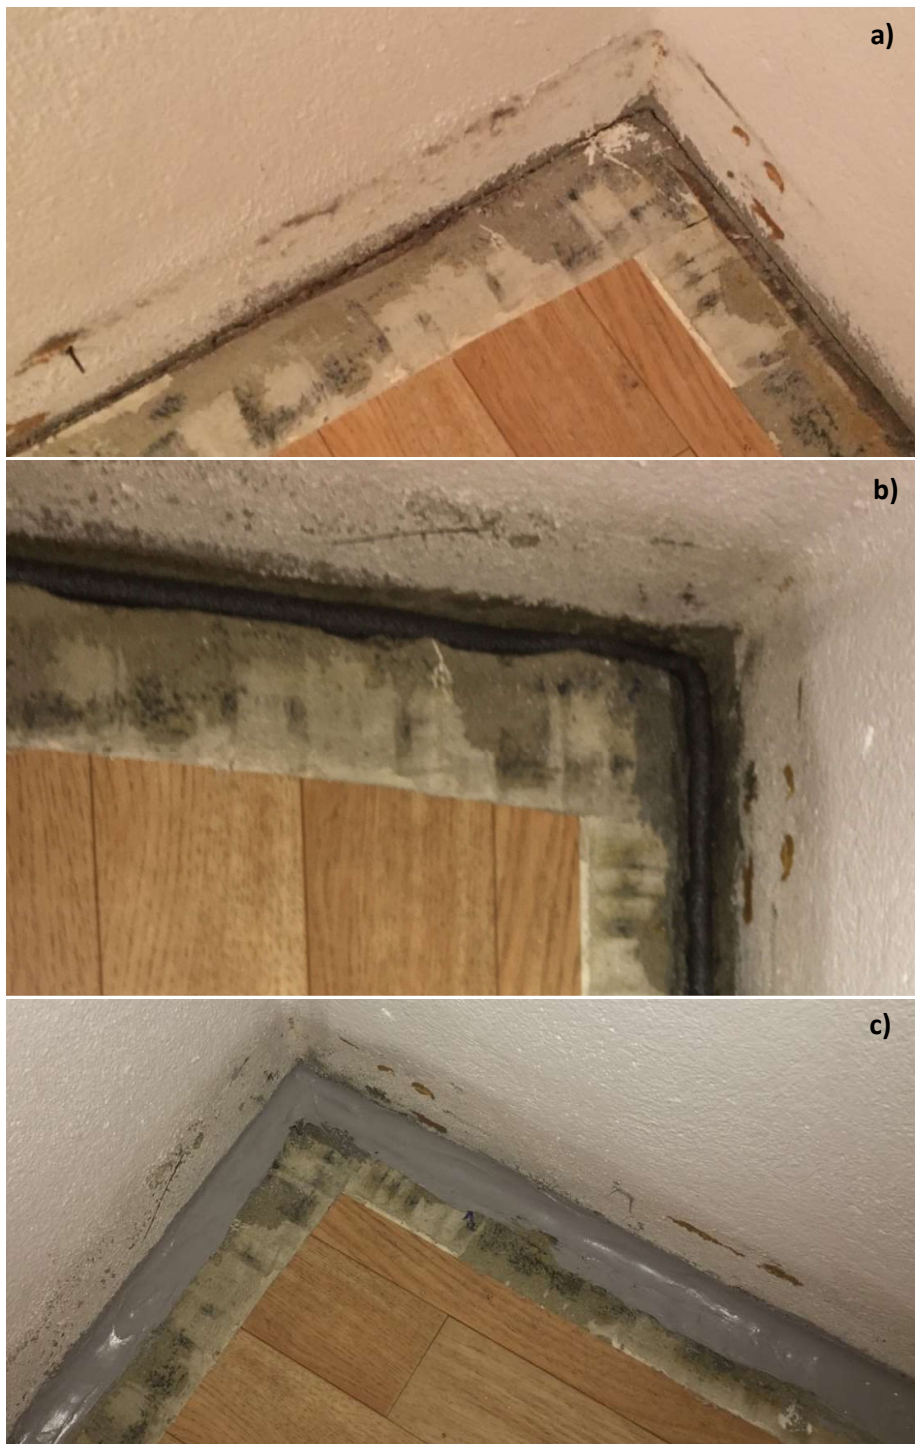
Tetting i overgang vegg/gulv. Plassering vist på tegning i figur 4.3.2-1, a) belegg revet av; b) store krympesprekker og utettheter; c) ferdig fuget.
